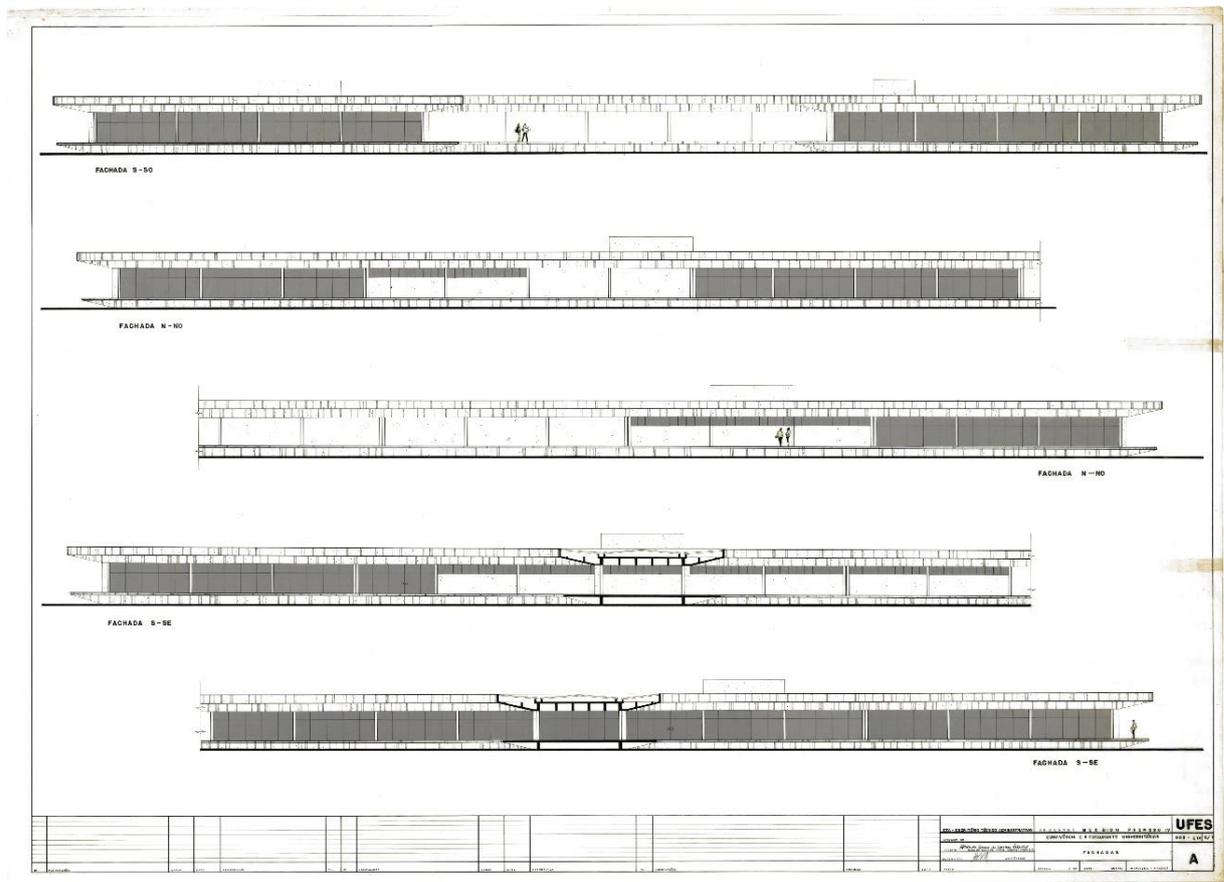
Fachadas do conjunto do centro de Convivência e Restaurante Universitários.
